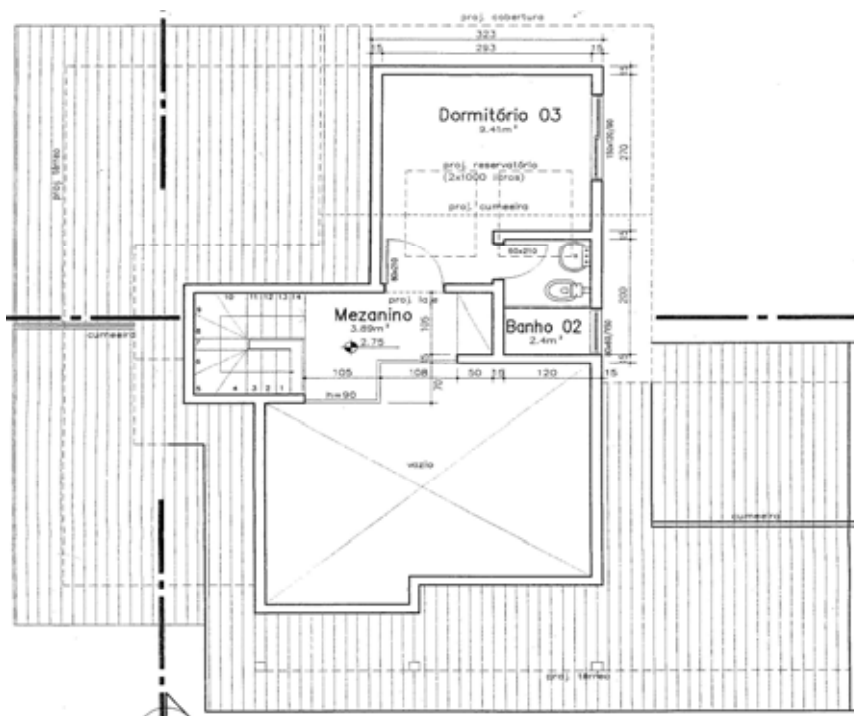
Projeto Estudo de Caso 2 - Planta Baixa Pavimento Superior
